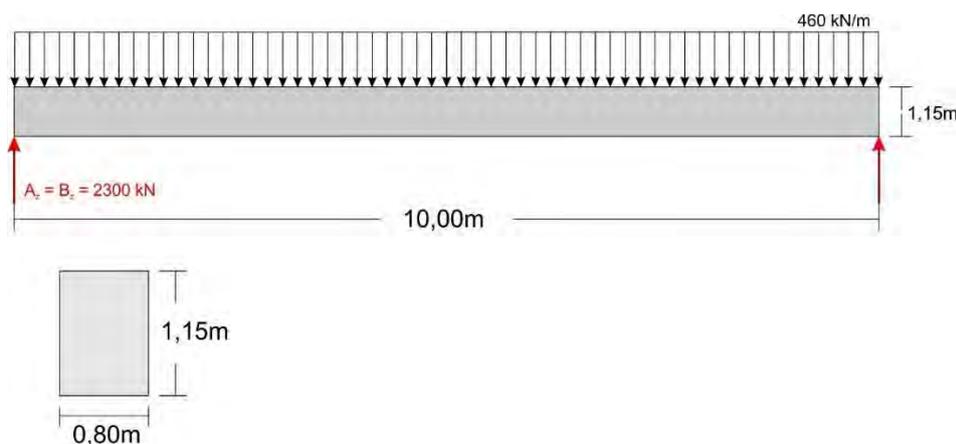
Statisches System der Stahlbetonbalken (Querschnitt)
